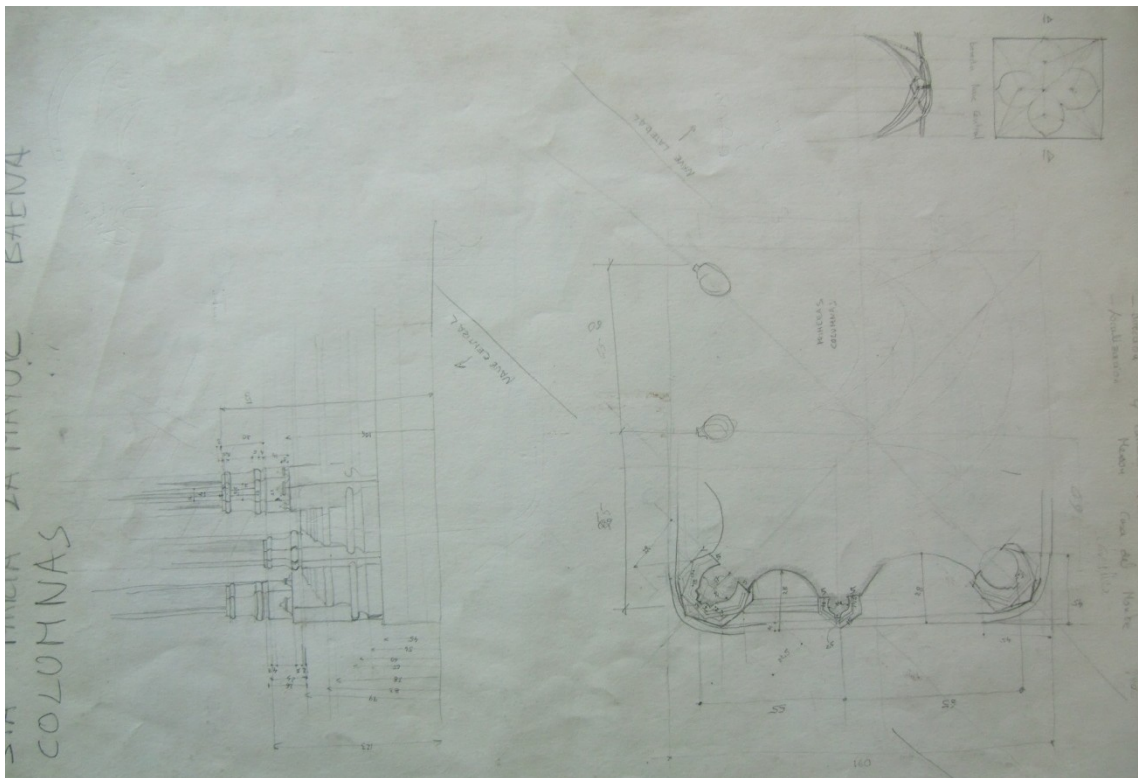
Elementos ornamentales columnas naves - Croquis del levantamiento realizado por el autor
